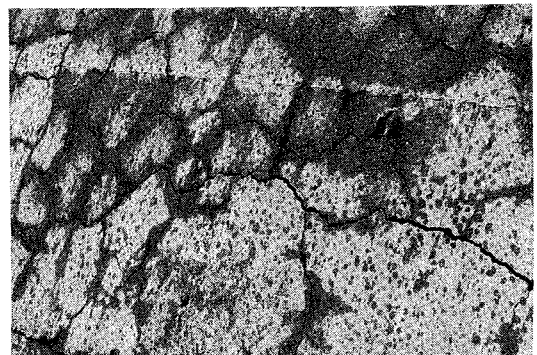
アルカリシリカ反応によって擁壁に生じたひびわれ (拡大図)
